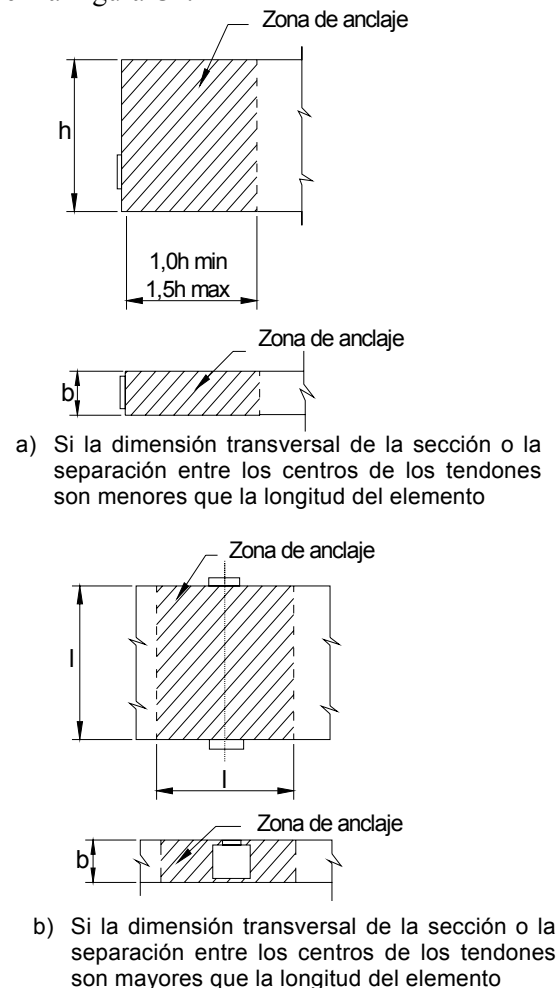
Geometría de las zonas de anclaje
